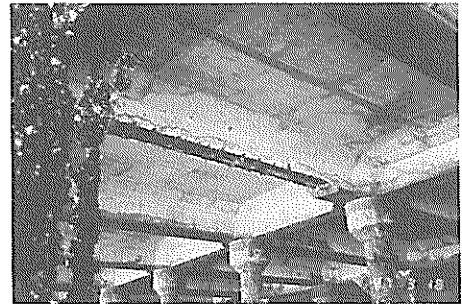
内部鉄筋の発錆によりかぶりコンクリートが剝落したはり部材
